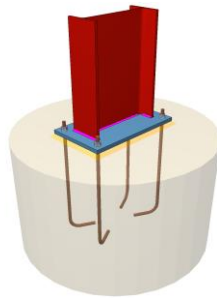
Placa de anclaje de los pilares de fachada
